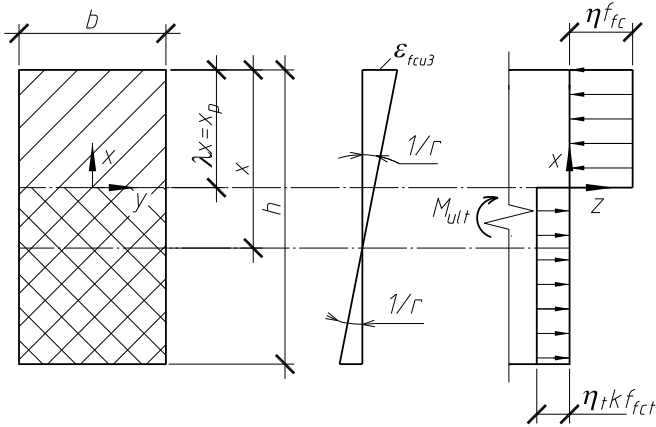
Схема зусиль та епюри напружень у перерізі, нормальному до поздовжньої осі згинального фібробетонного елемента прямокутного перерізу без поздовжнього армування при розрахунку його за міцністю
